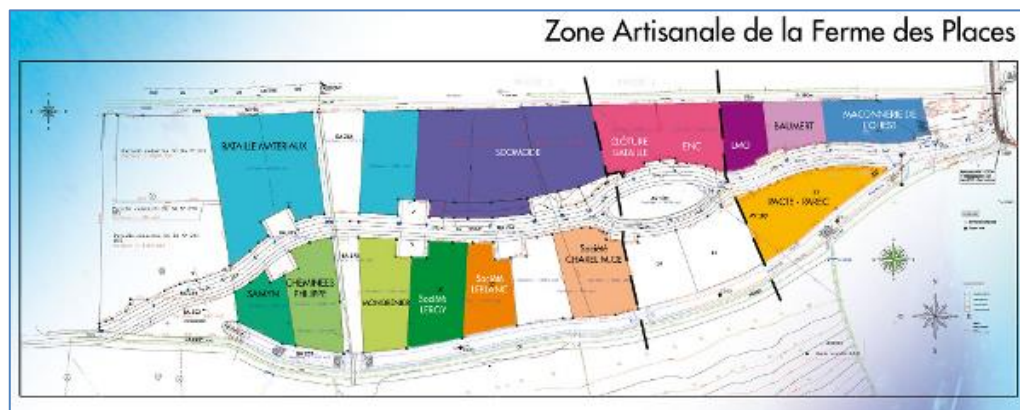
plan de la ZAC de la ferme des places (source : <http://www.ville-pont-audemer.fr>)
